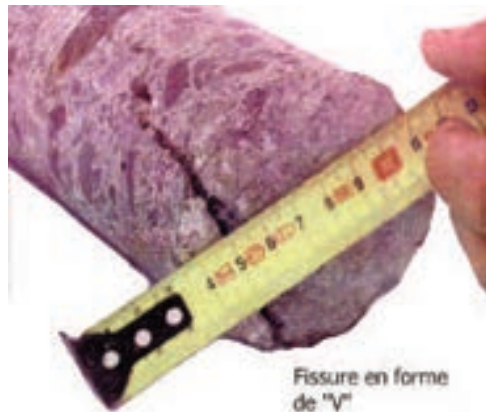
fissure en forme de « V » ouverte mais de faible profondeur (crédit photo Poinneau)
